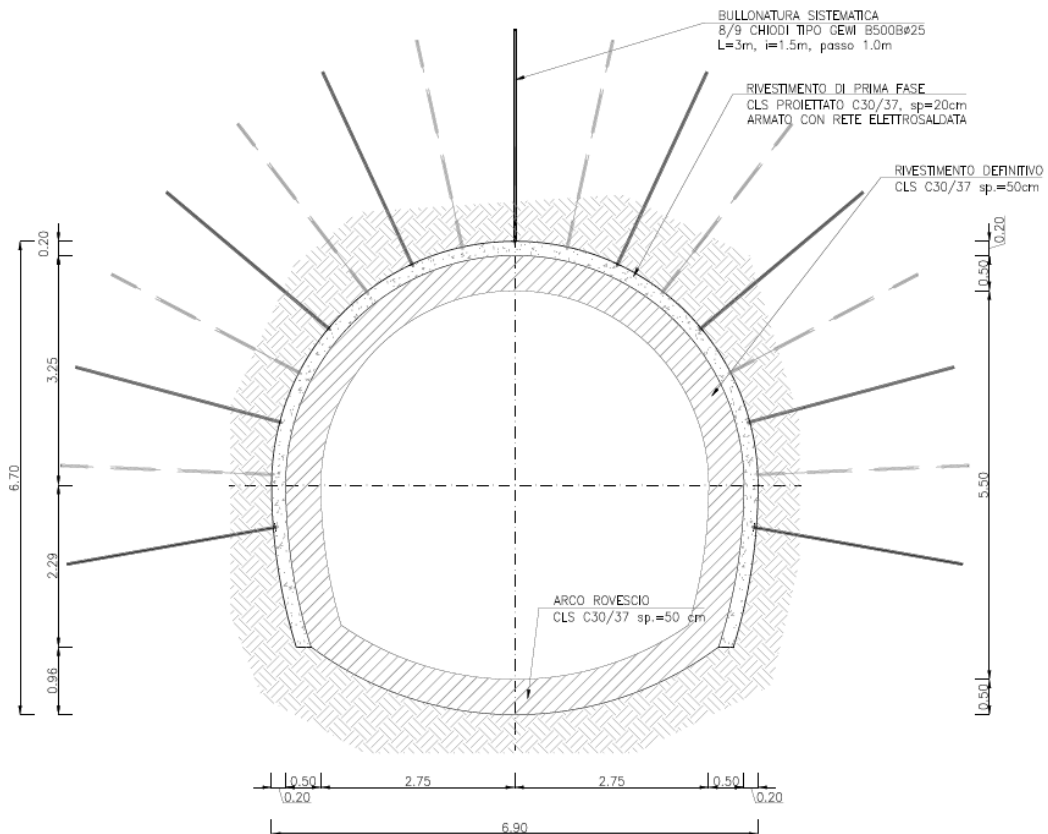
Sezione tipo GI-1: geometria del cavo e interventi di sostegno
